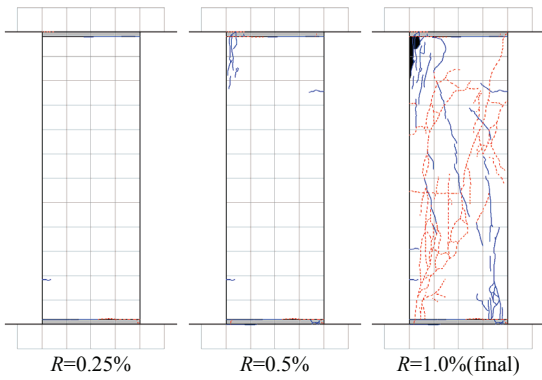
U1/2-0.1 ひび割れ状況
